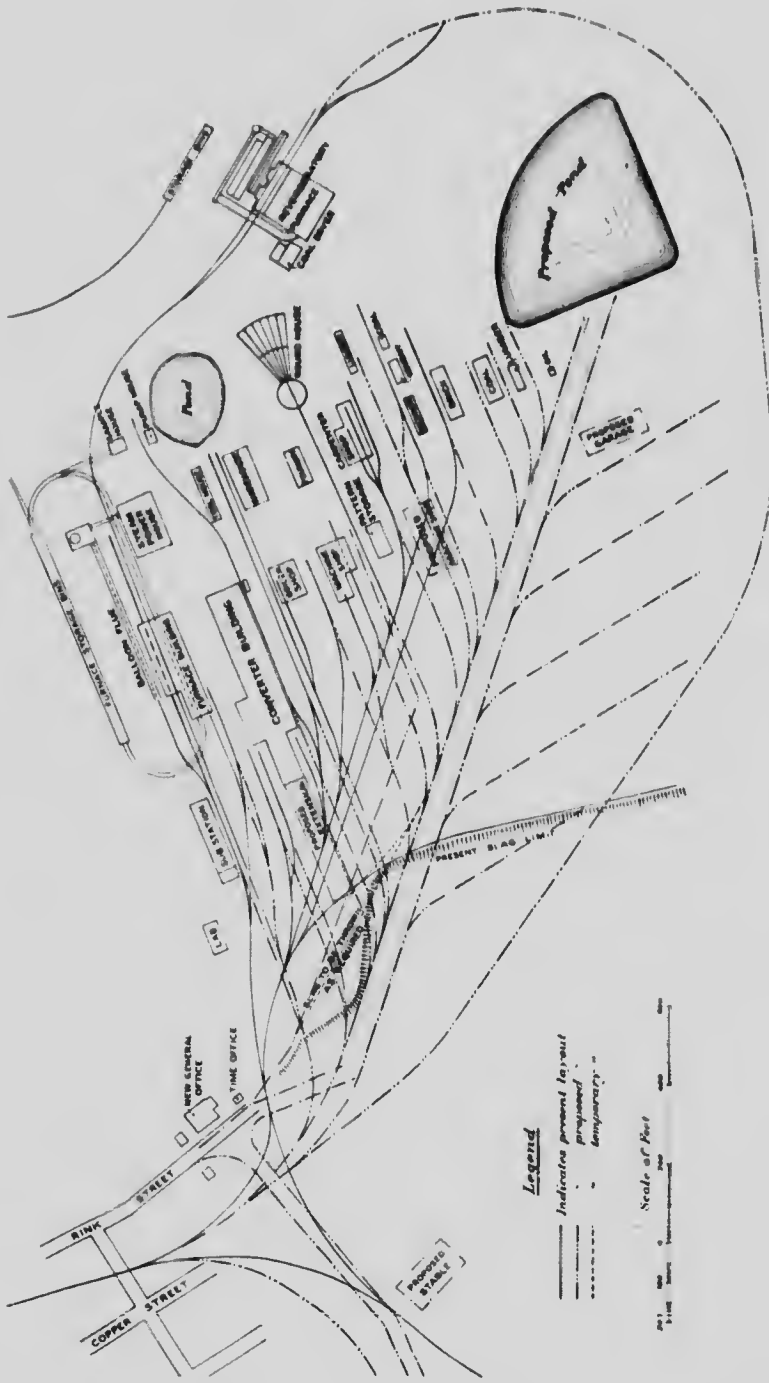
Plan de l'installation Copper Cliff, Canadian Copper Co.
